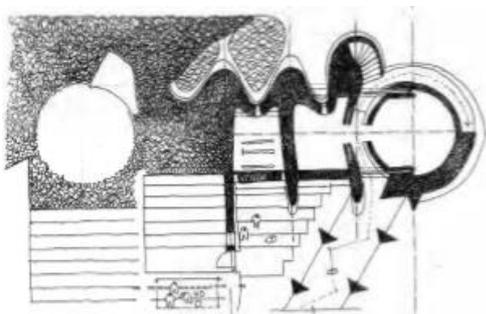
Planta de Piso 0. Fonte: (Hall. 2011: 19)
